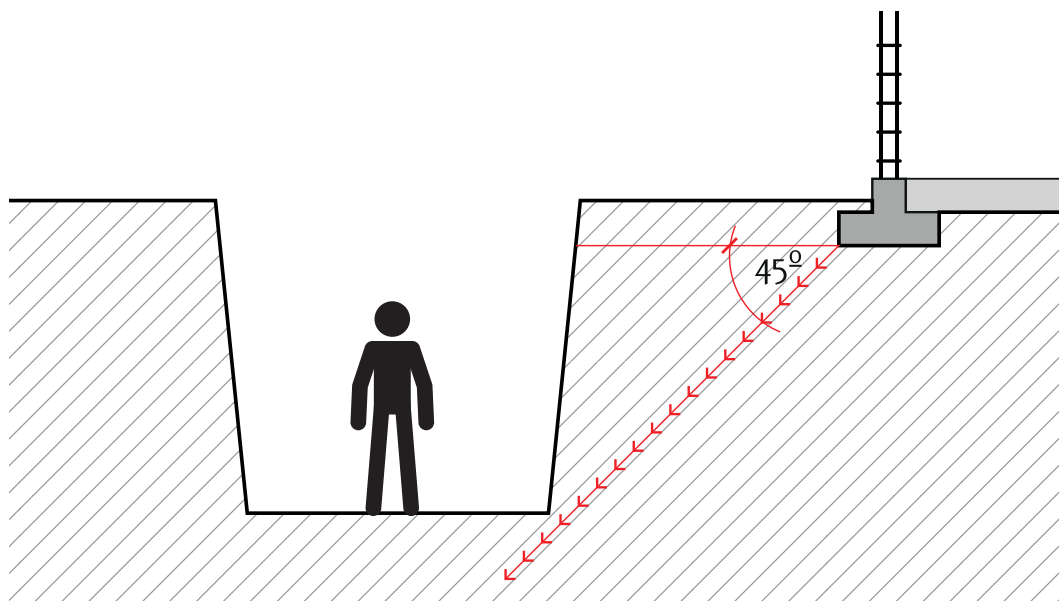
Condición deseable de influencia estructural sobre las paredes de una excavación.
